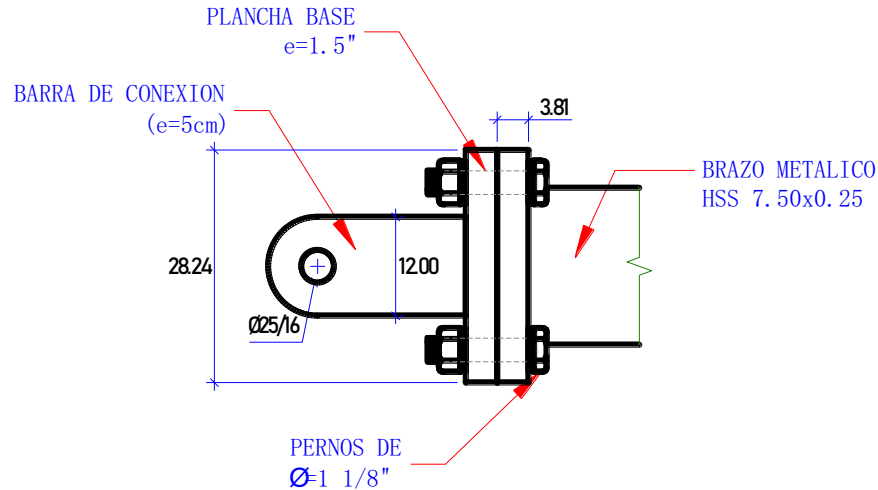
Detalle 2 Conexión brazo metálico HSS 7.50x0.25- Barra de conexión.
